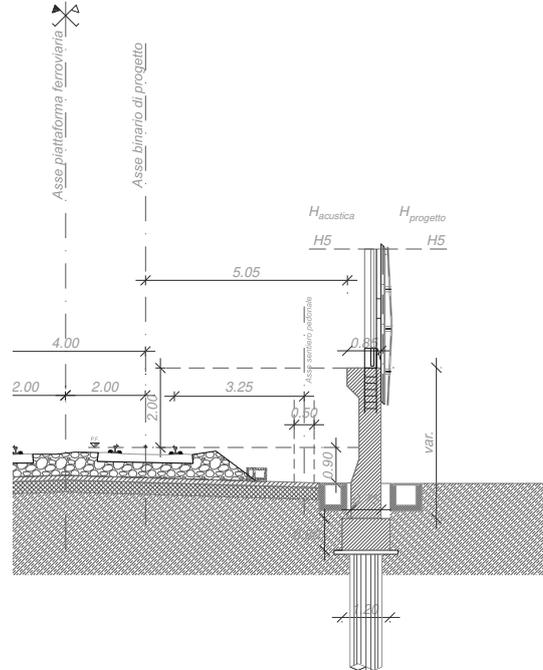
Sezione tipo tipologica BA “HS” rettificato senza manufatto prefabbricato fondato su OdS
